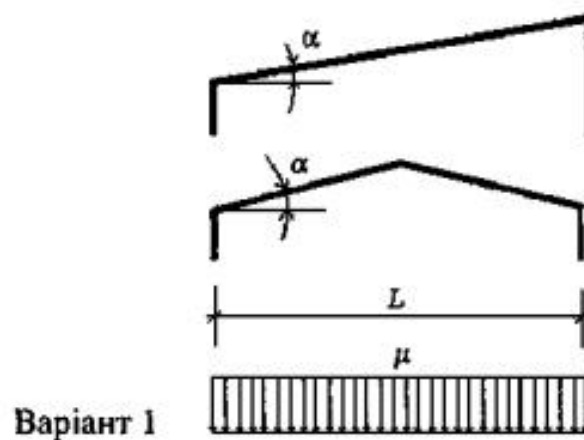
Схема снігового навантаження для заданої будівлі
